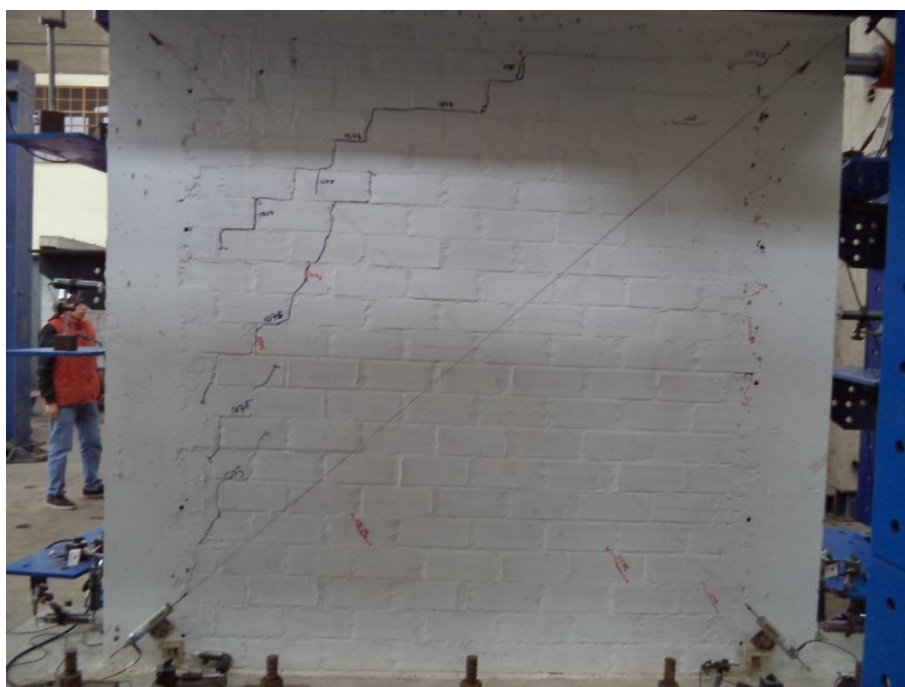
Grietas diagonales siguiendo el recorrido de las juntas de la albañilería
